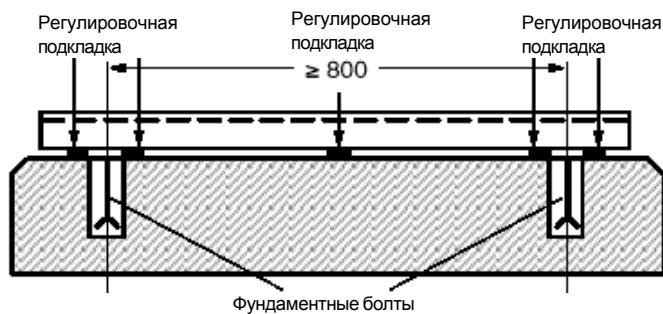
Расположение регулировочных подкладок под опорной плитой
